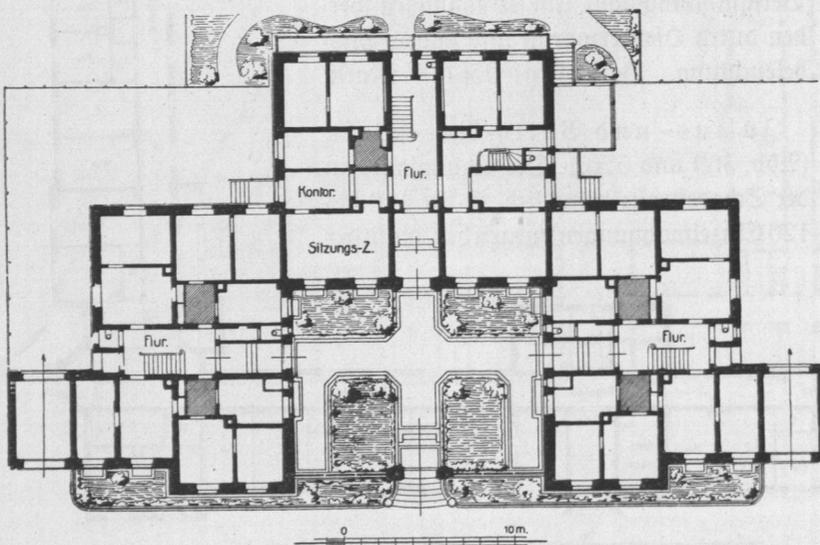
Heine-Anstl, Erdgeschoß, Grundriß.
